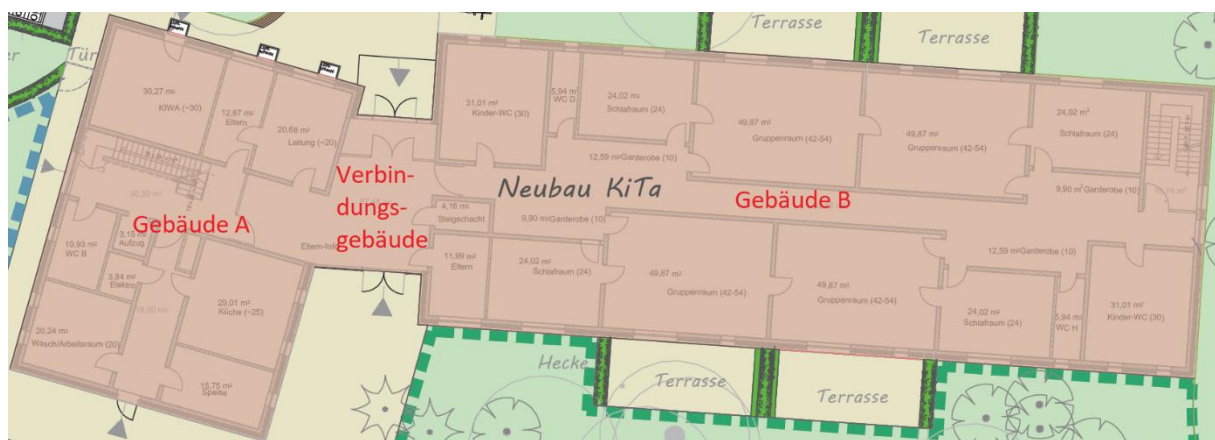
Architektenlageplan mit Teilbereichkennzeichnungen
